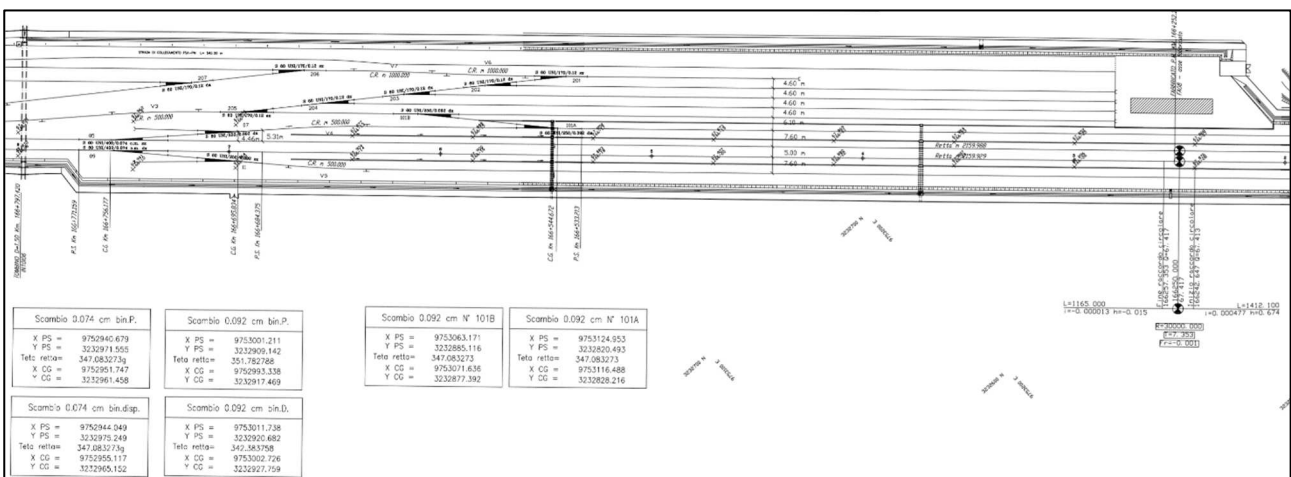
Planimetria tratta evento dal punto iniziale di svio al PM Livraga (fonte: RFI)
